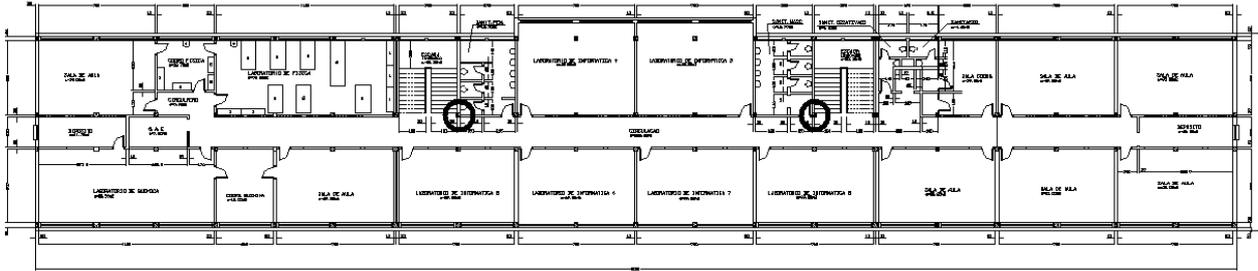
Localização sugerida para os acionadores do sistema de alarme de incêndio no quarto pavimento.
